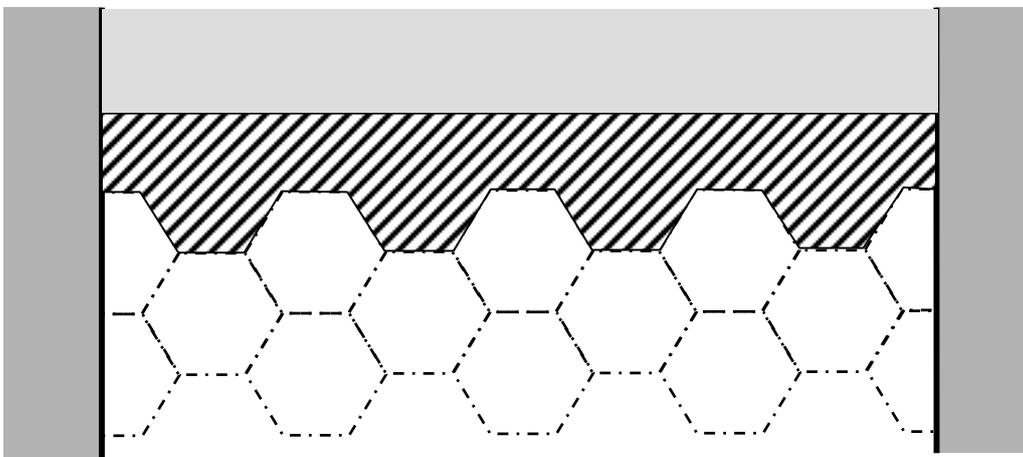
fin de CUD à dalles indépendantes sur une poutre transversale en béton coulé en place (hachurée).
